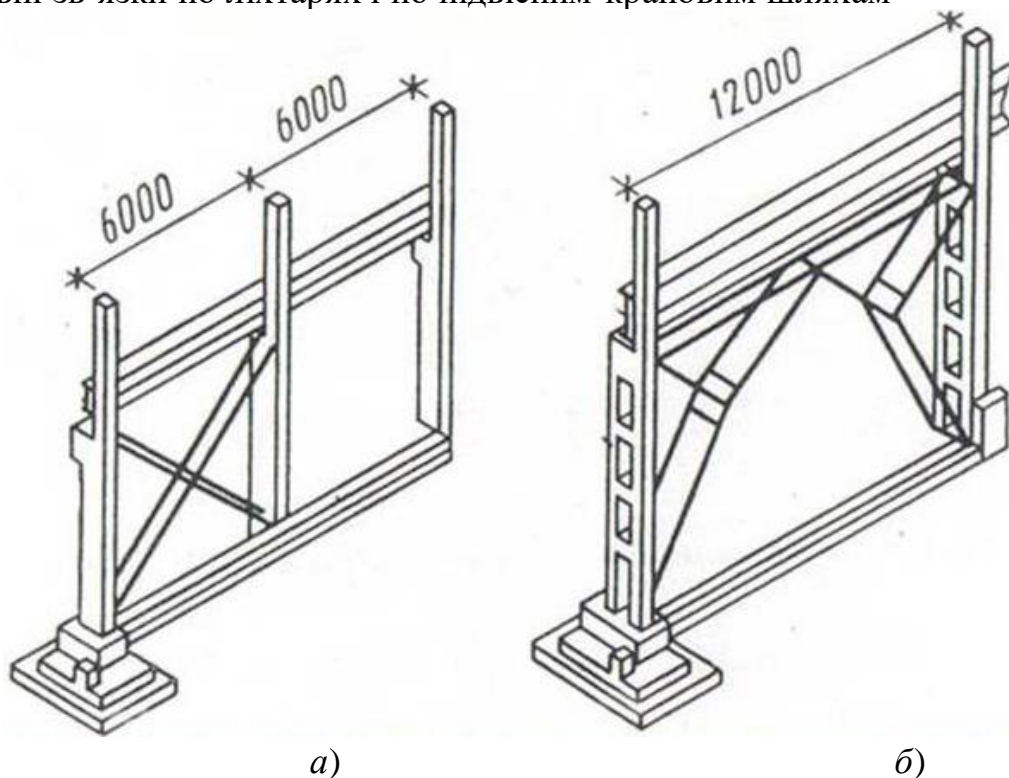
Зв'язки: *а* – при кроці колон 6 м; *б* – при кроці колон 12 м.
